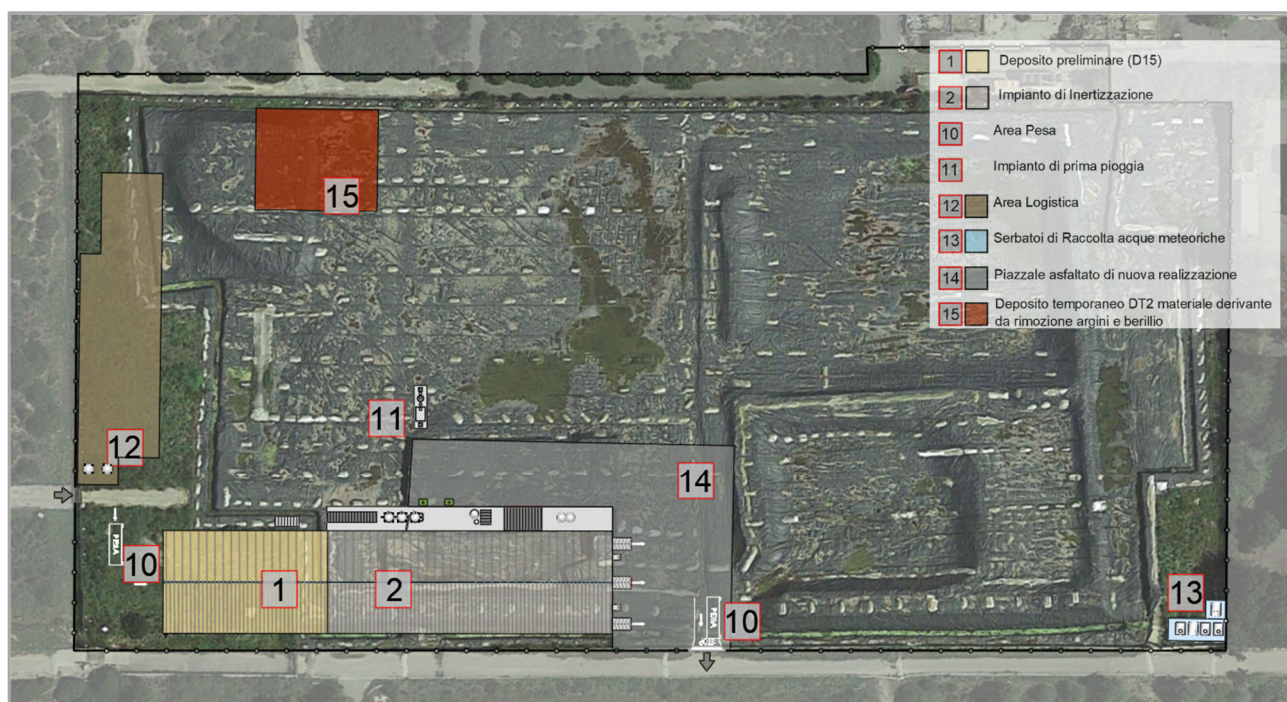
Ortofoto dell'area palte con individuazione di alcune aree di lavoro
